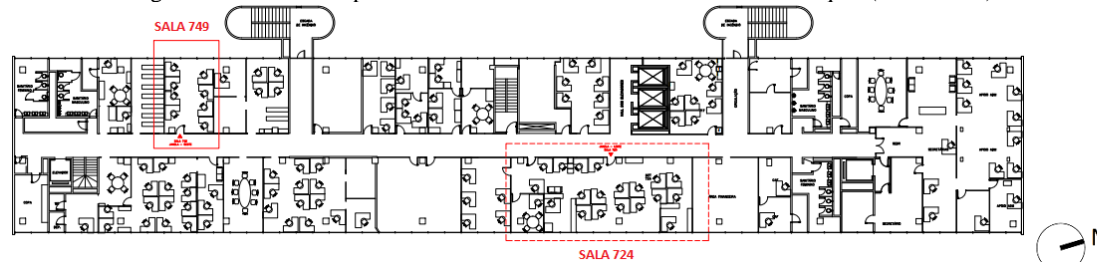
Planta do 7º pavimento com ambientes monitorados em destaque. (Pré-*Retrofit*)
